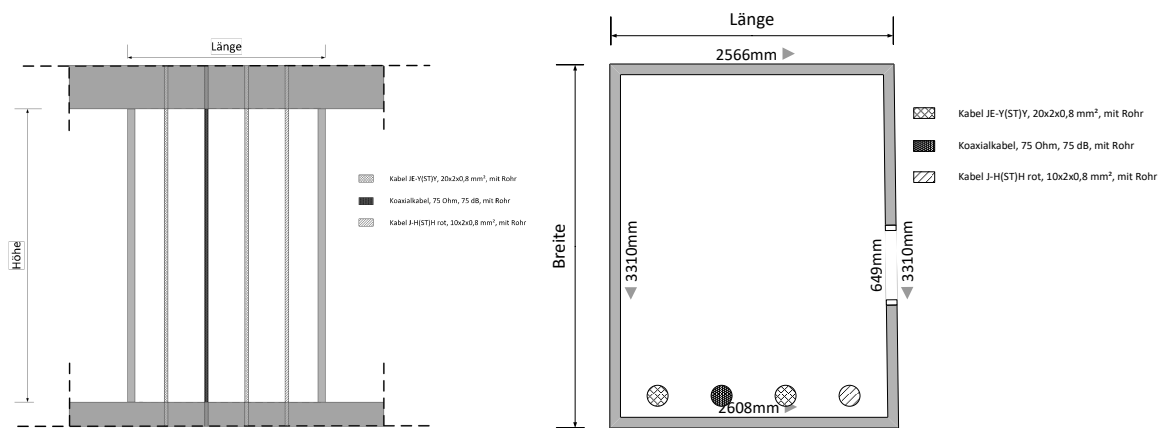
Vertikaler und Horizontaler Schnitt - Installationsschacht Elektro ⁴⁸⁷
